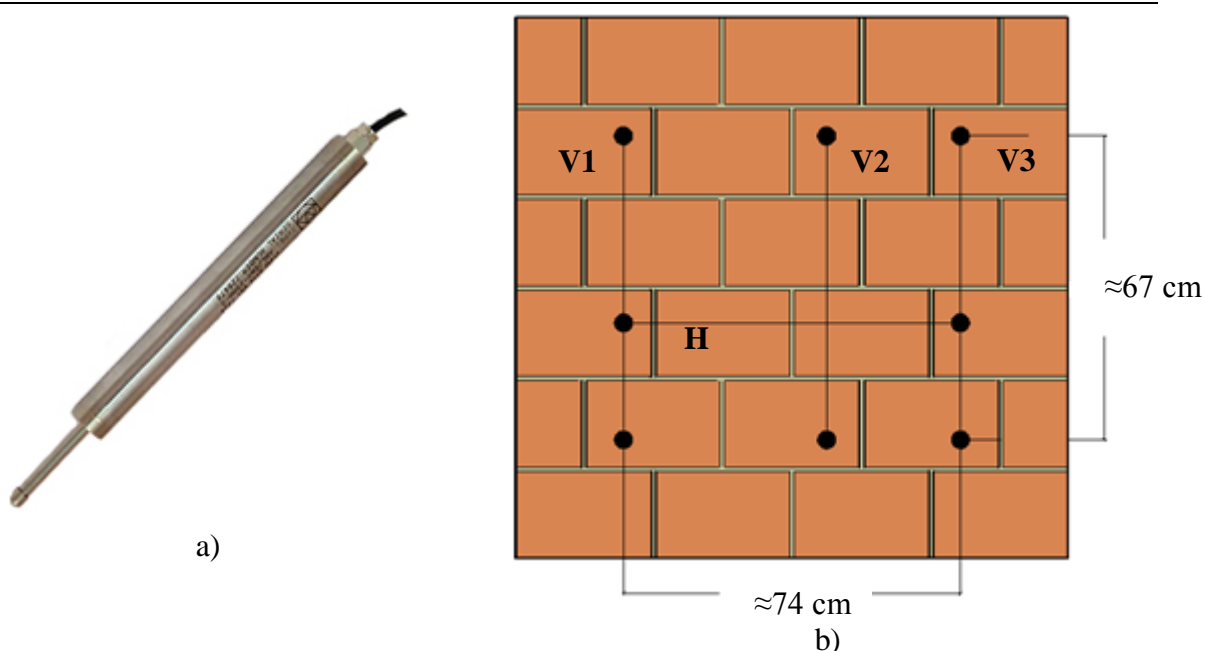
Equipamento e disposição dos LVDT's: a) LVDT; b) Ponto de fixação dos LVDT's
